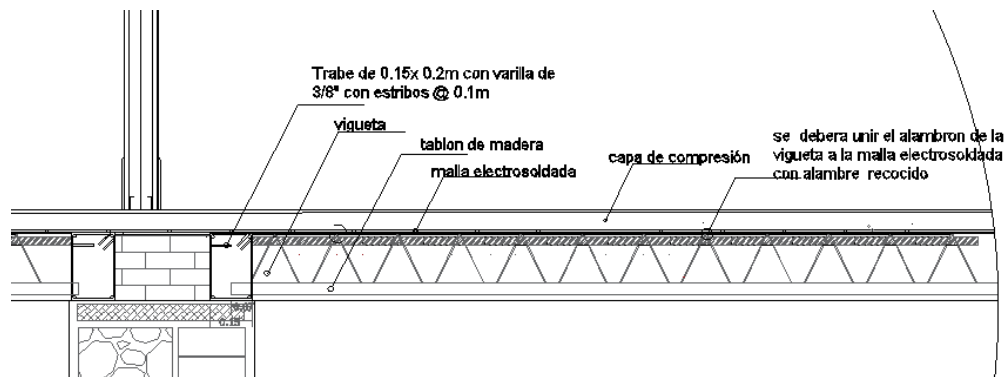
detalle de losa en intersección de muro. Elaboración propia
